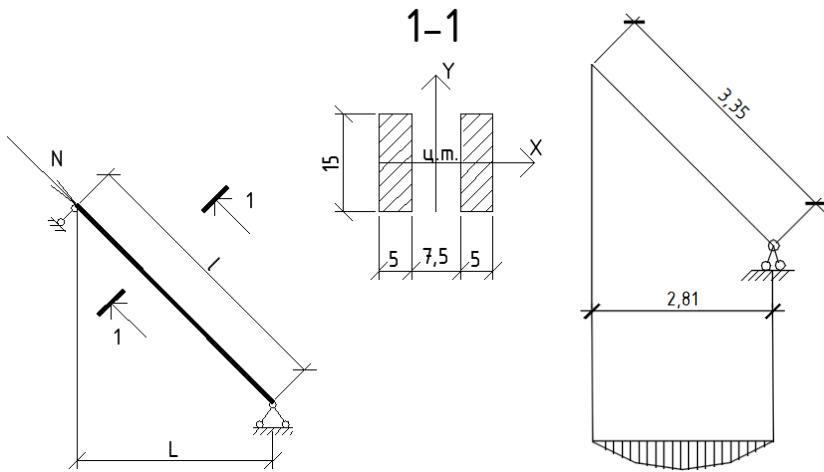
Расчетная схема подкоса стропильной ноги
